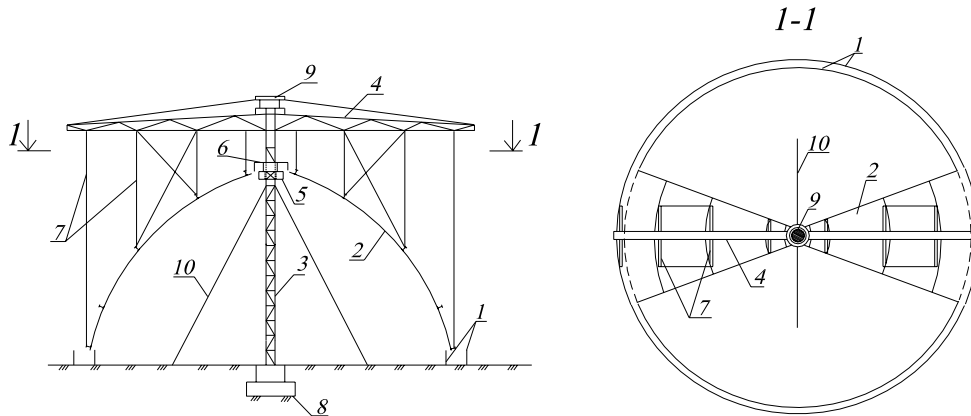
Монтаж опалубки купола: 1 – щиты опалубки нижнего опорного кольца; 2 – опалубка купола; 3 – временная опора; 4 – консольная стрела; 5 – неподвижное кольцо; 6 – опалубка верхнего опорного кольца; 7 – связи; 8 – фундамент временной опоры; 9 – гидродомкрат; 10 – растяжки.
